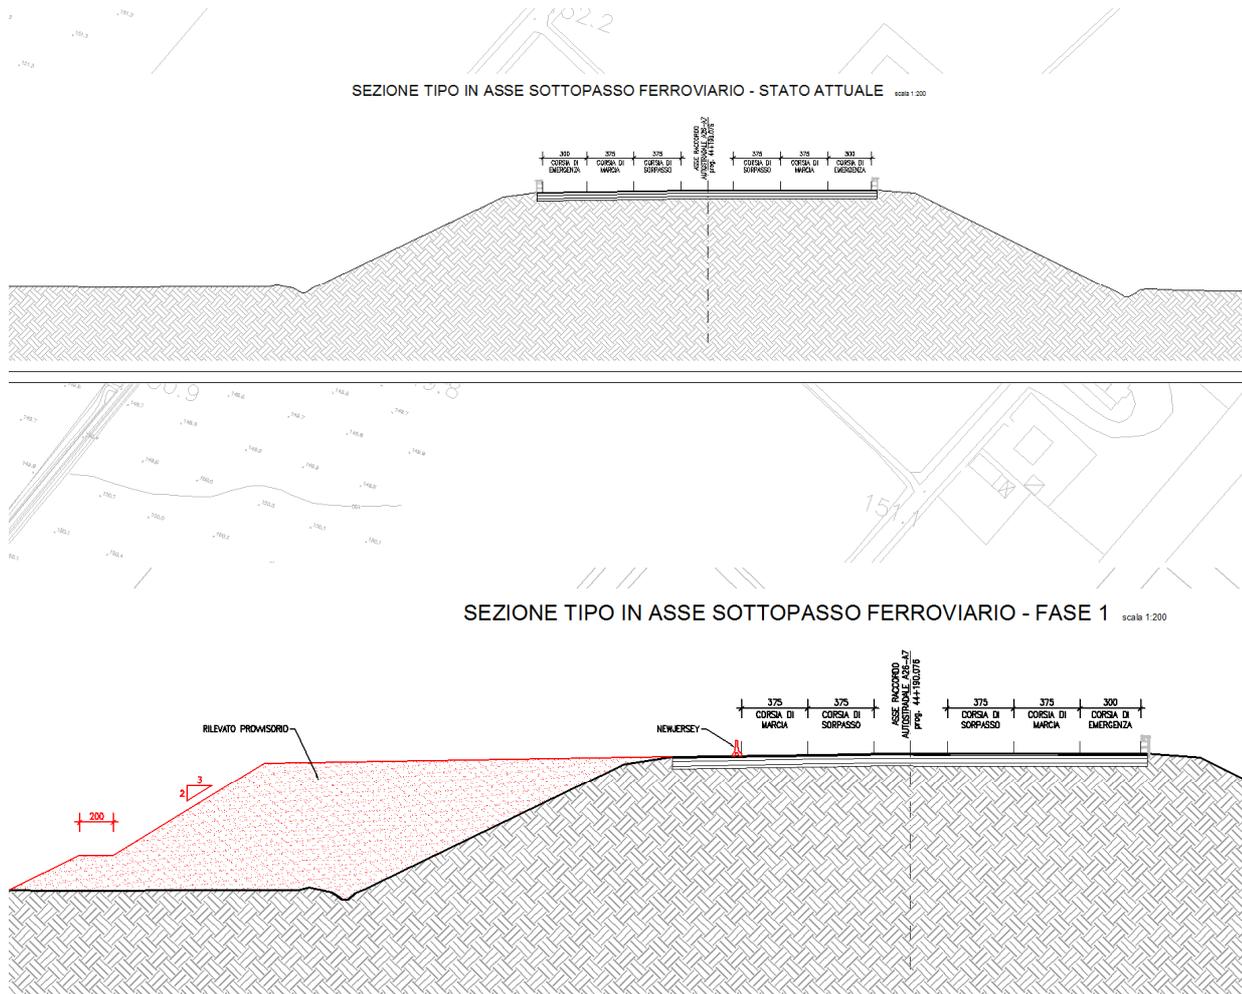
Confronto condizione ante-operam e la fase di realizzazione del rilevato temporaneo. Sezioni trasversali
